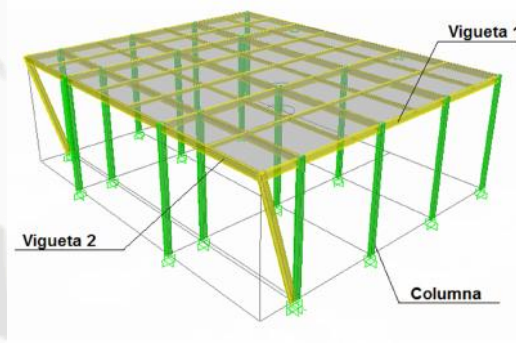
Ubicación de los diferentes tipos de vigas en la estructura principal.
